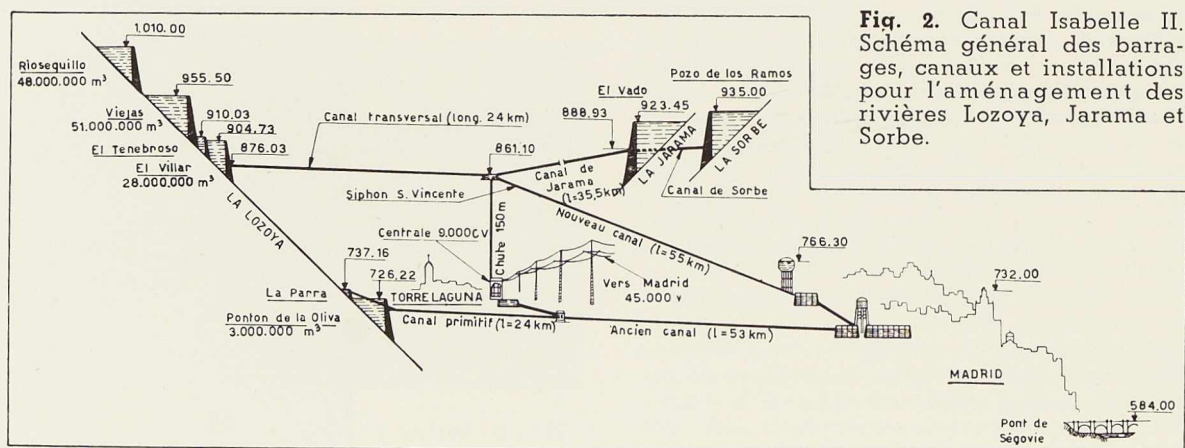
Canal Isabelle II. Schéma général des barrages, canaux et installations pour l'aménagement des rivières Lozoya, Jarama et Sorbe.
